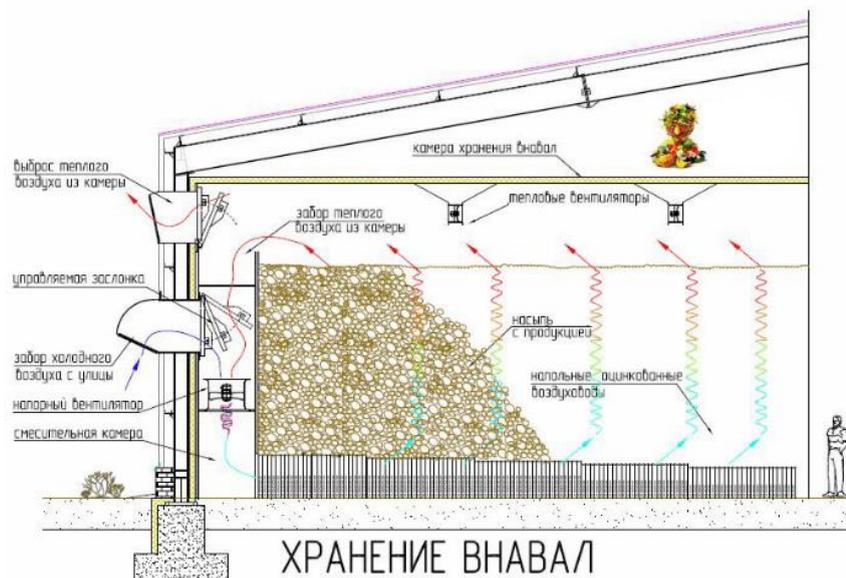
Активное вентилирование картофеля при его навалном размещении в хранилище
